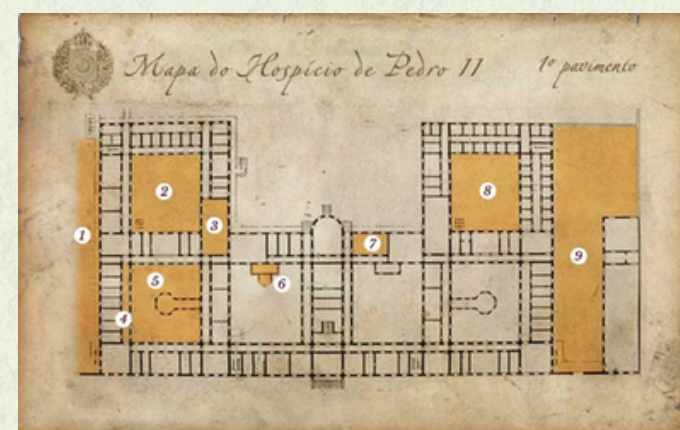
Planta Baixa 1º Pavimento Hospital de Pedro II.
